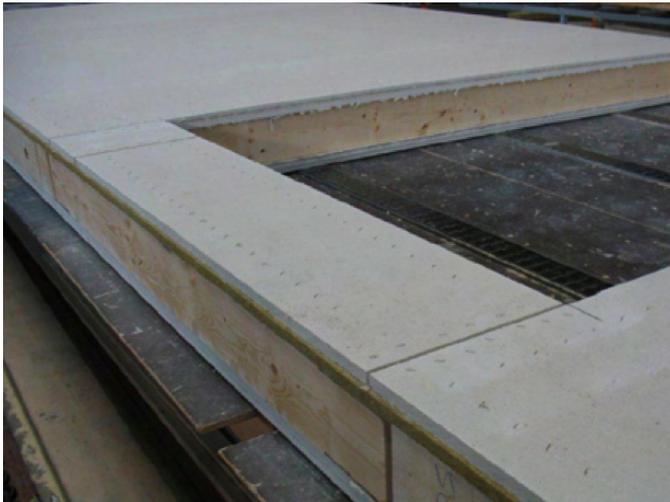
Anschluss raumabschließenden Wand / Decke mit Steinwolledämmstreifen
